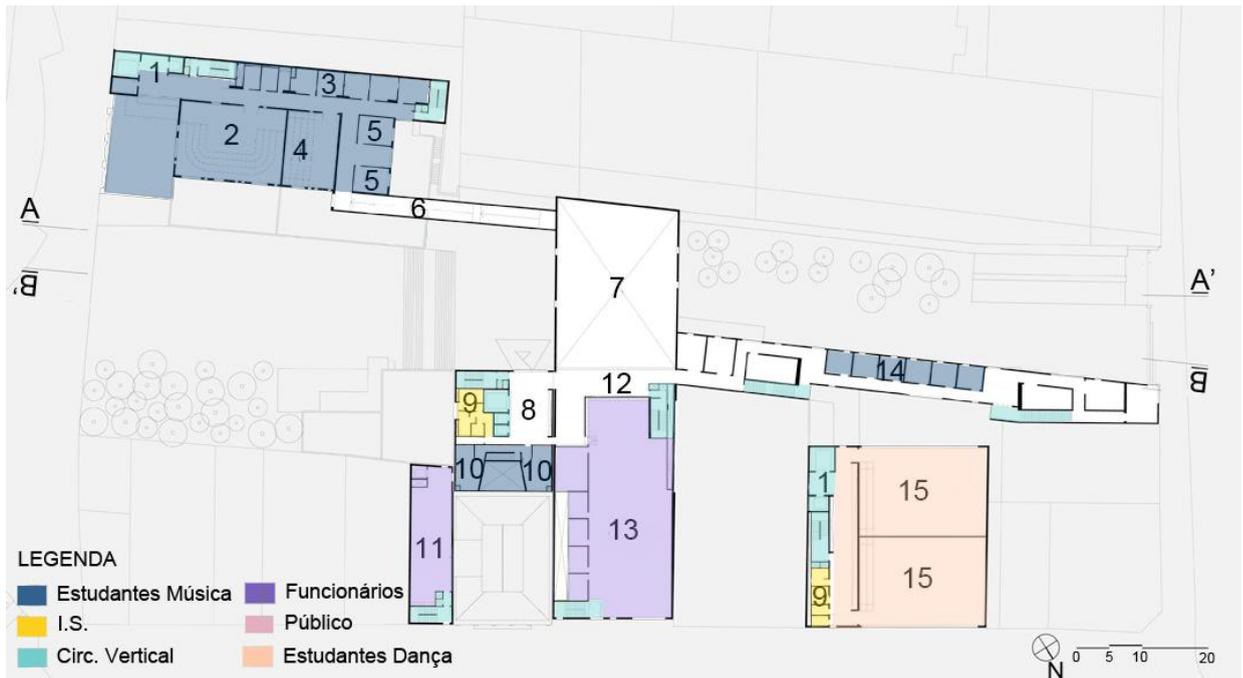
PLANTA SEGUNDO PAVIMENTO - ESCALA GRÁFICA
